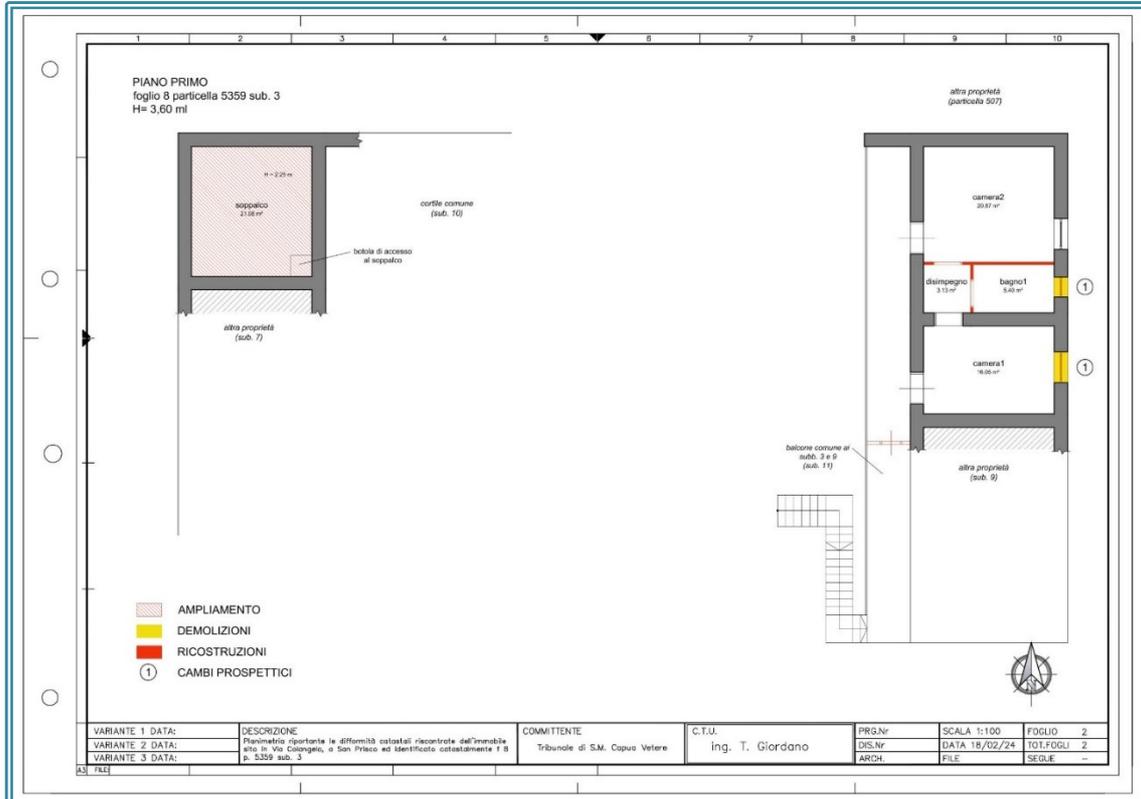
Schema difformità LOTTO 8 (Piano Primo)
